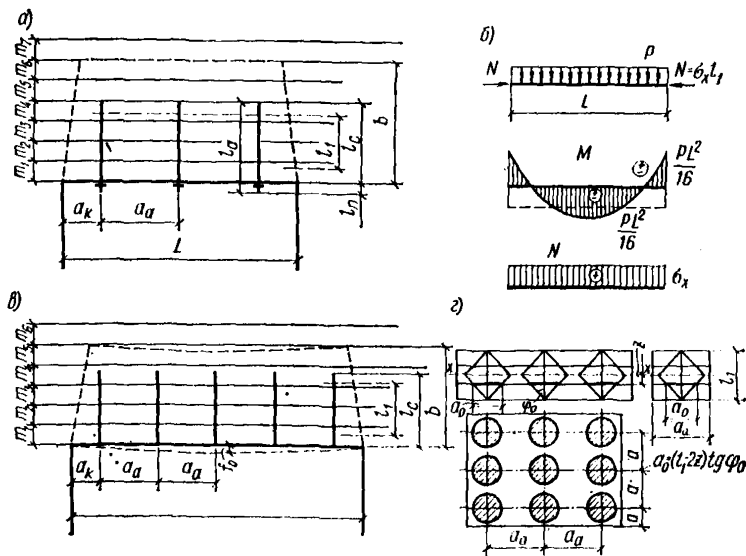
Схемы к расчету параметров анкерной крепи кровли
